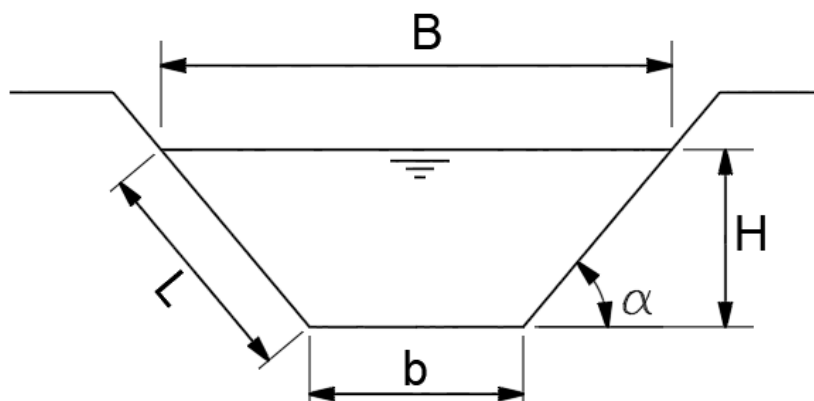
Calculul canalelor cu nivel liber. Exemplu canal trapezoidal.
